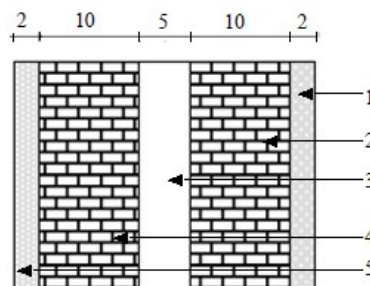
Coupe verticale, Eléments d'un mur extérieur.
